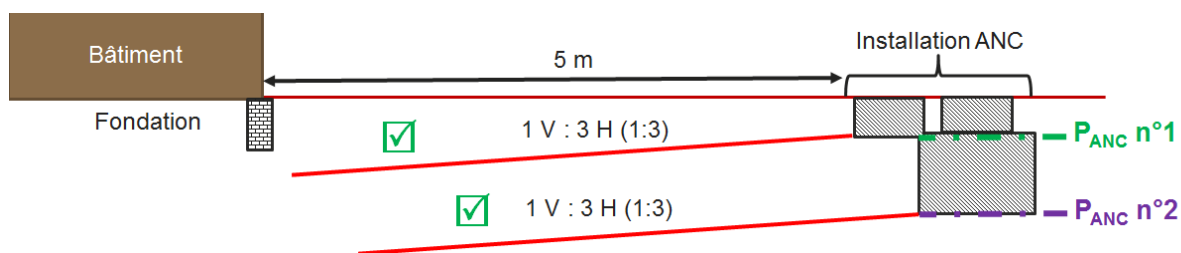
Ecart minimum entre fondation et installation d'ANC.
